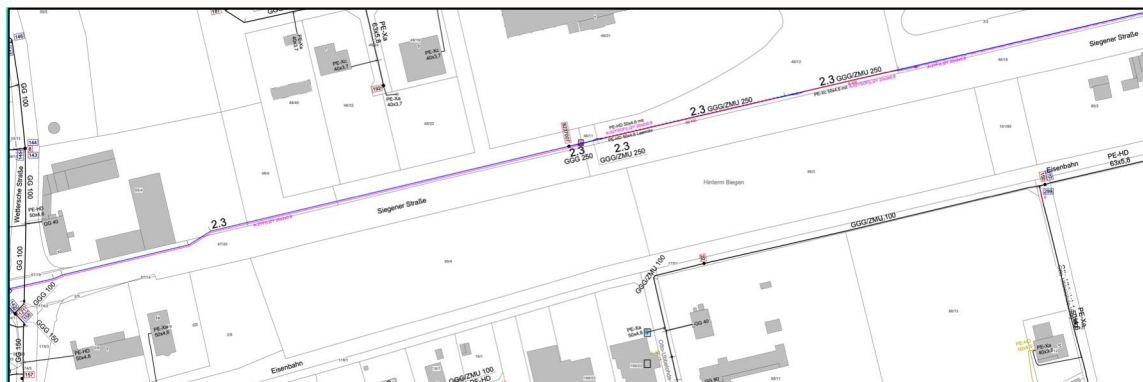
Lageplan ZMW (Auszug Stellungnahme zur Löschwasseranfrage)
